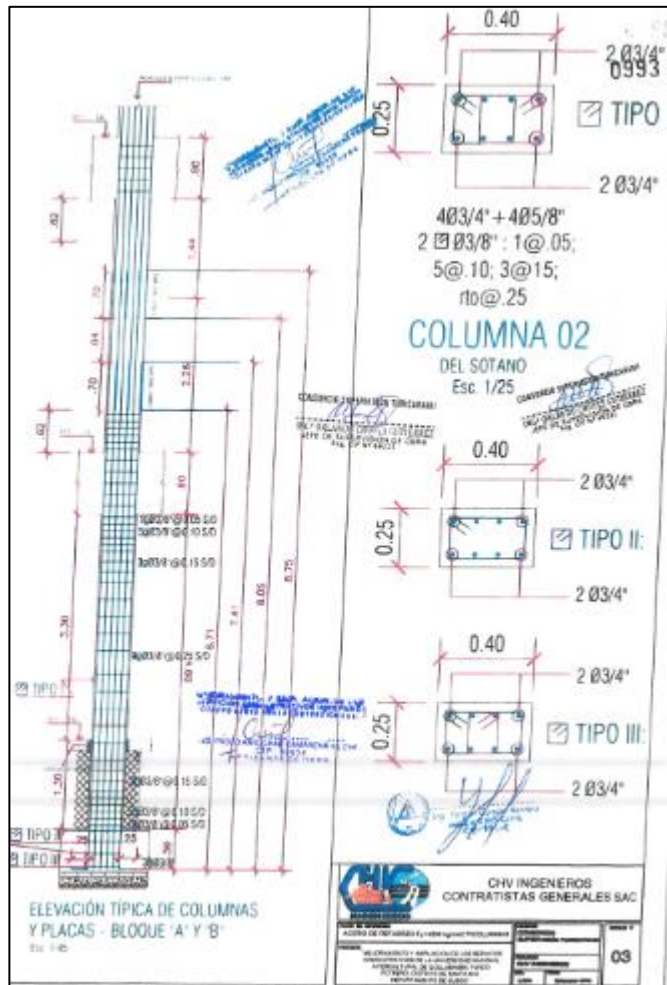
Plano de Acero Vertical, estribos y ganchos. Fuente: Informe Mensual de la Obra UNIQ.
